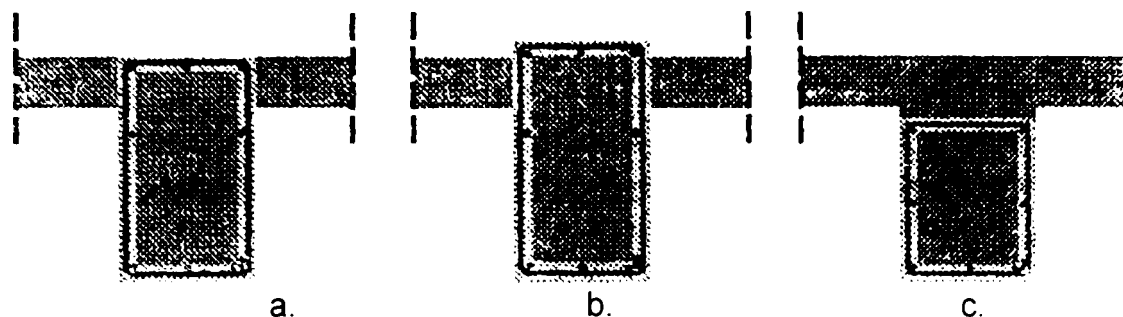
Procedee utilizate la consolidarea grinzilor din beton armat prin cămășuieli din beton armat
